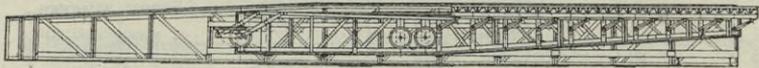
Längsschnitt durch den Träger der Seitenöffnung mit eingerollter Brücke.
